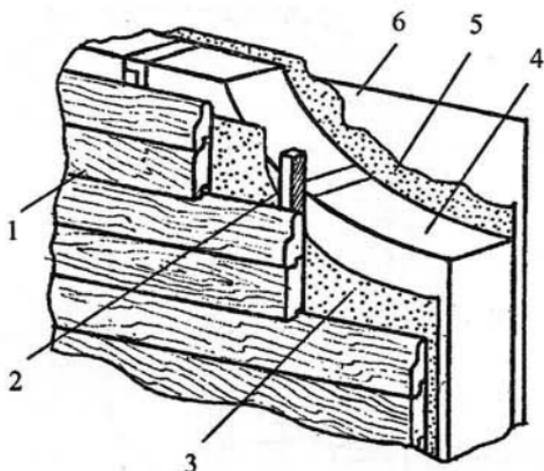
Внутреннее утепление стены каркасного дома, обшитой вагонкой:
